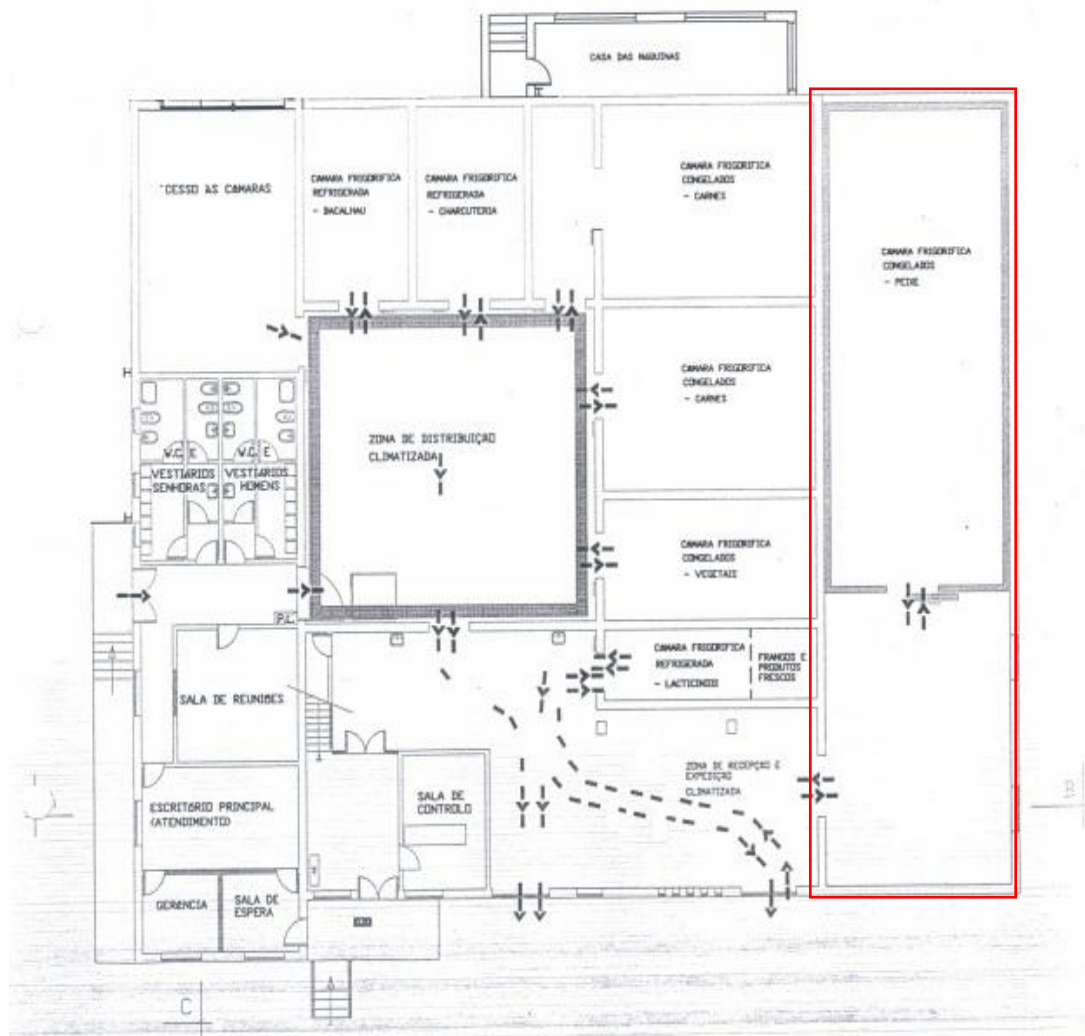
Planta da construção atual com indicação da zona ampliada.
